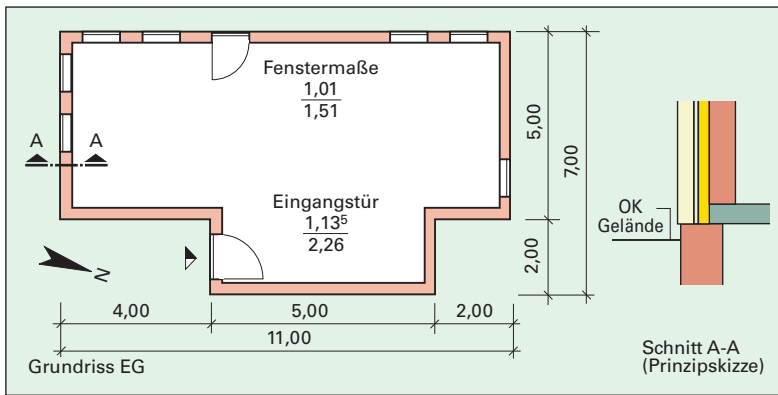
Erdgeschoss, zweischaliges Natursteinmauerwerk
